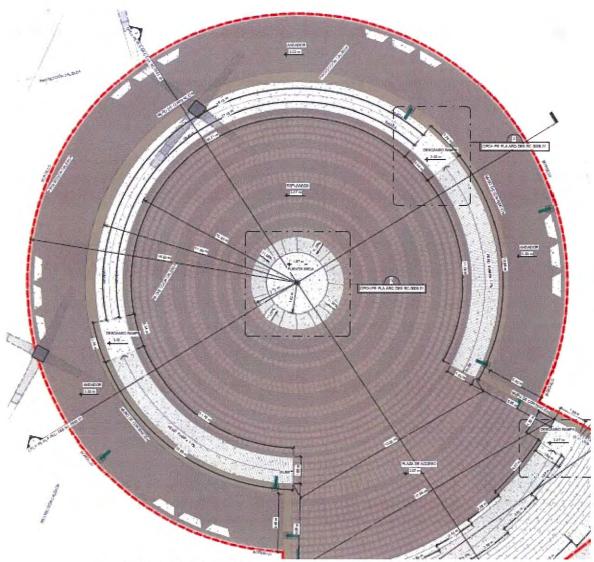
Planta de plazoleta del desembarque Rosario Castellanos.
